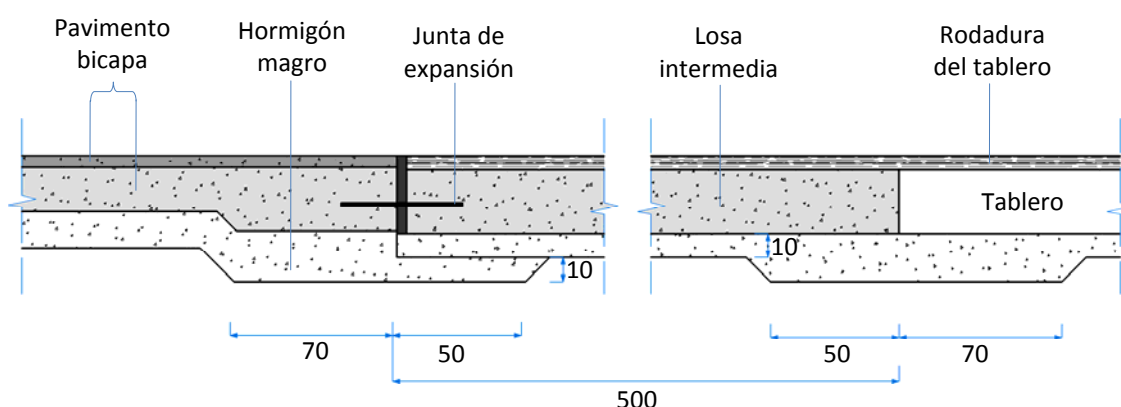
Transición de un pavimento bicapa y un puente (losa intermedia sobrepuesta)
